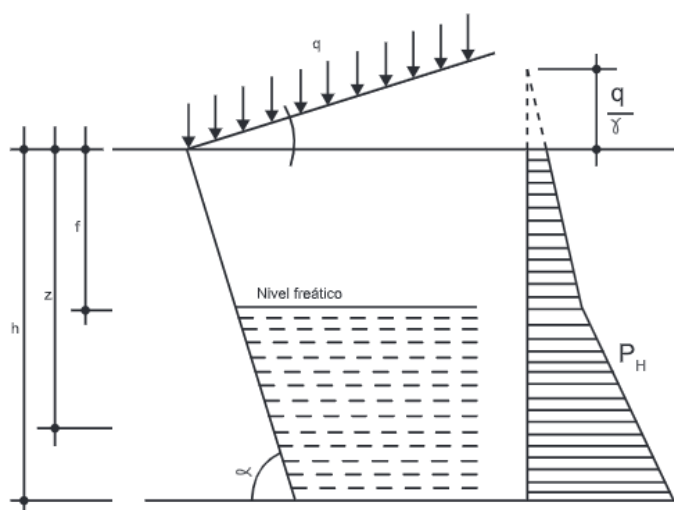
Croquis de un muro en terreno anegado. (NB1225002-1)
